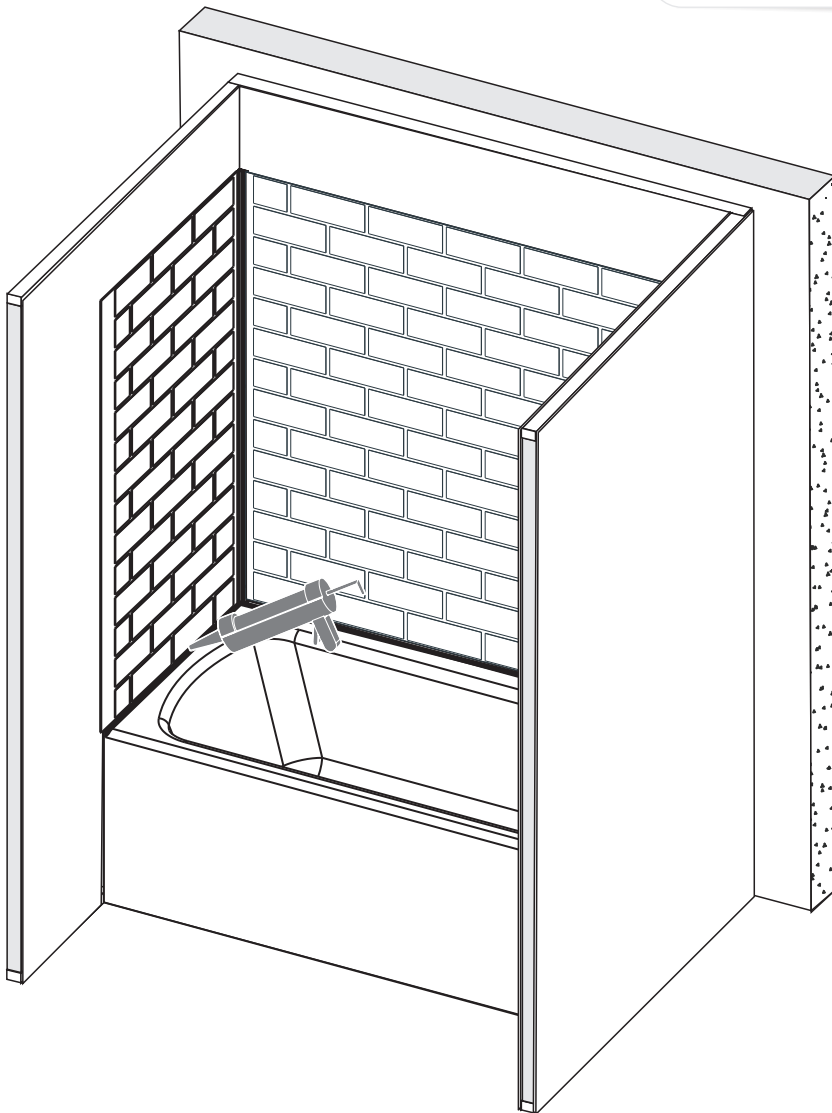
Appliquer l'adhésif sur le profil mural et installer le panneaux latéraux dans le mur profil comme indiqué dans illustration.
